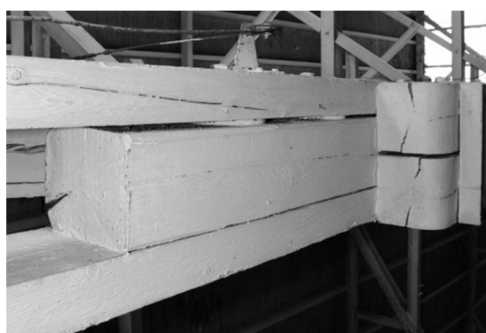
Niewłaściwa naprawa ukośnego elementu pasa górnego
